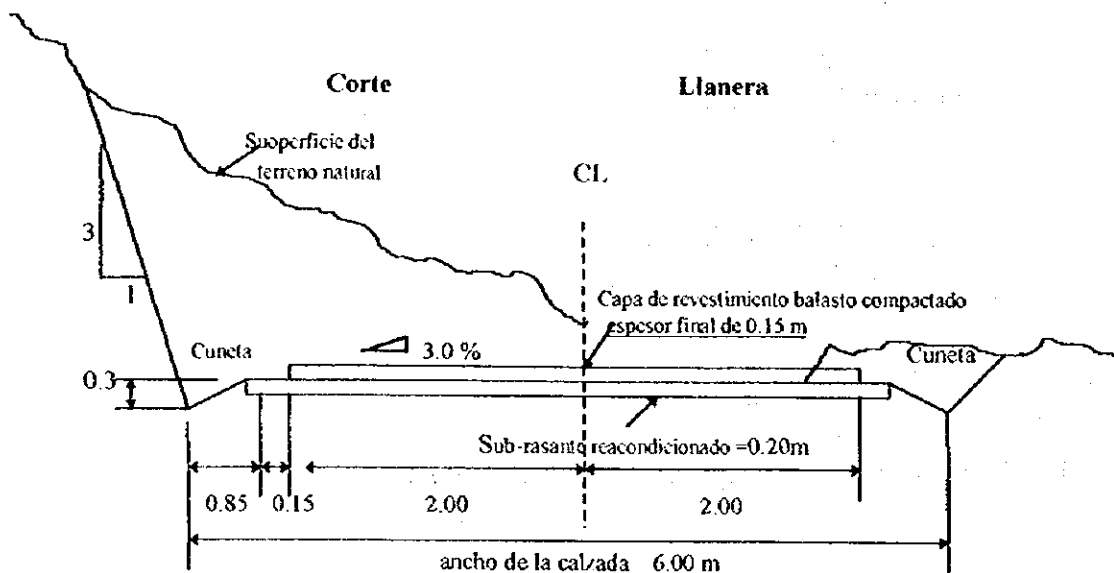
② Croquis sección transversal en Corte y Llanura
